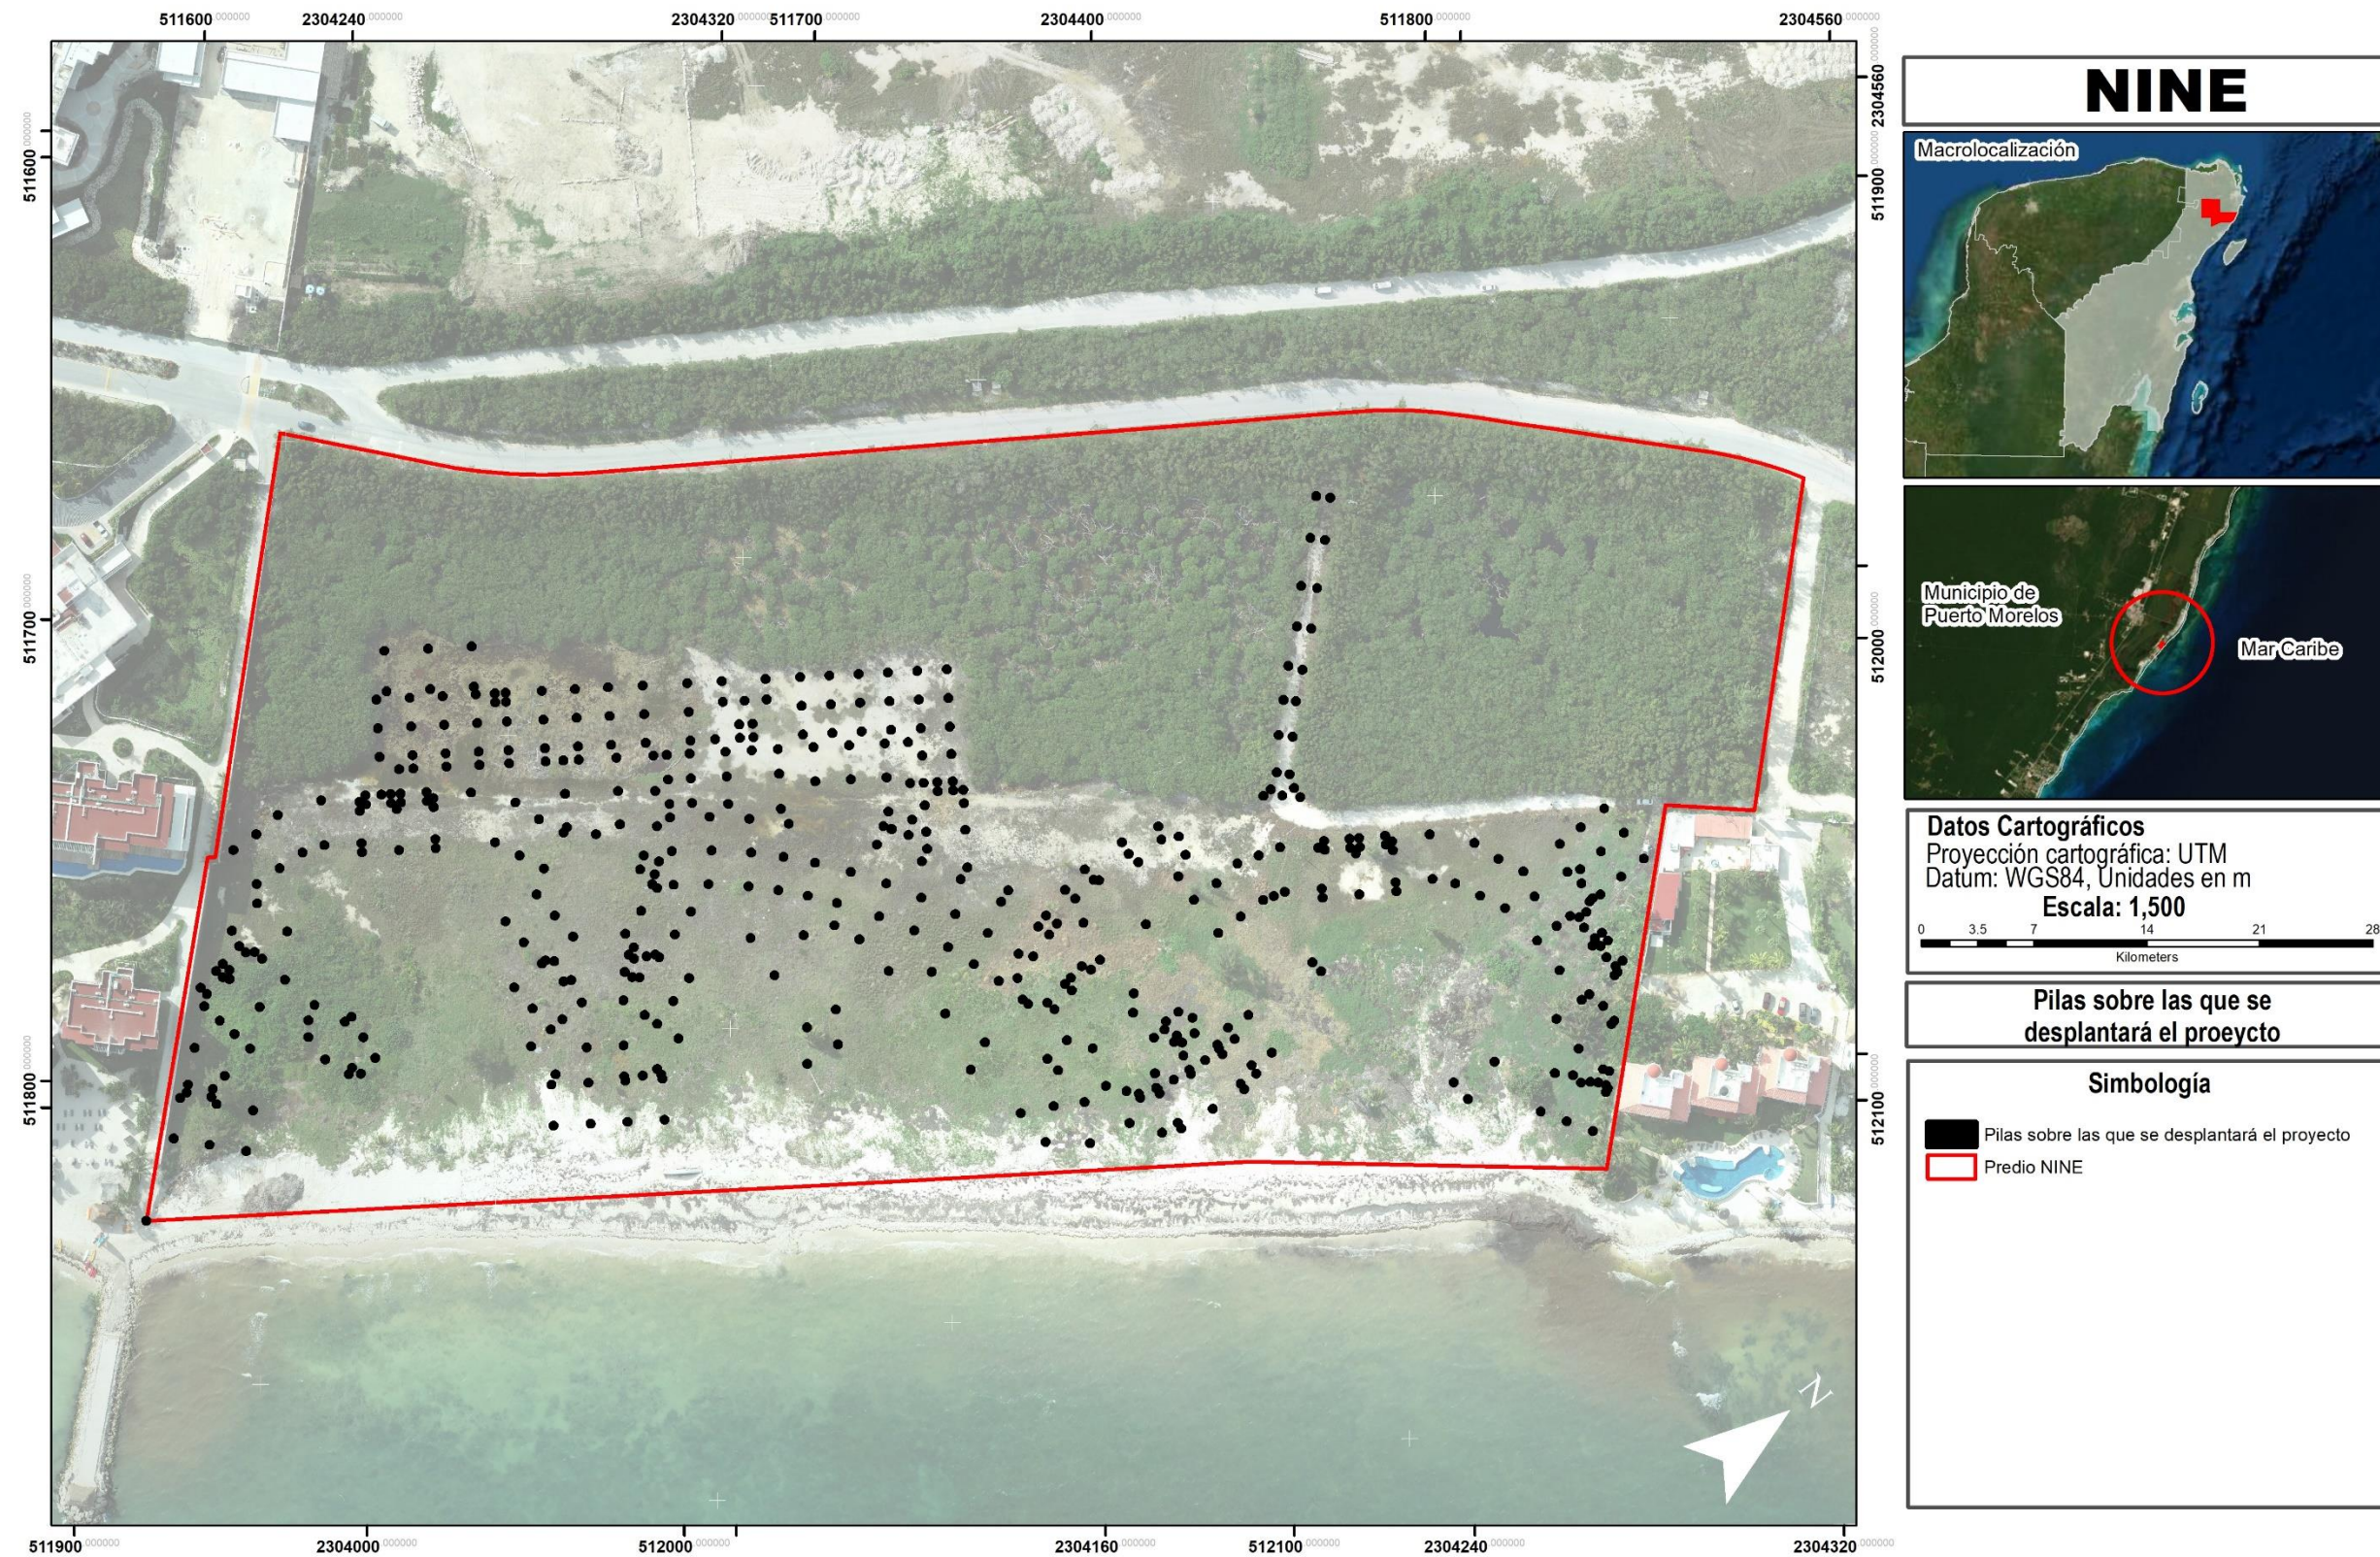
Desplante de las pilas que conforman el proyecto NINE.
